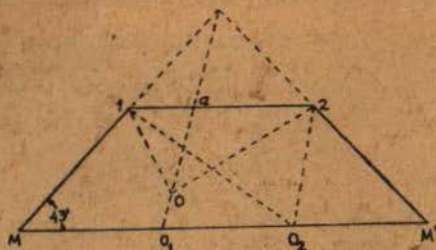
Épura de construção de uma ponte do tipo n.º 2
